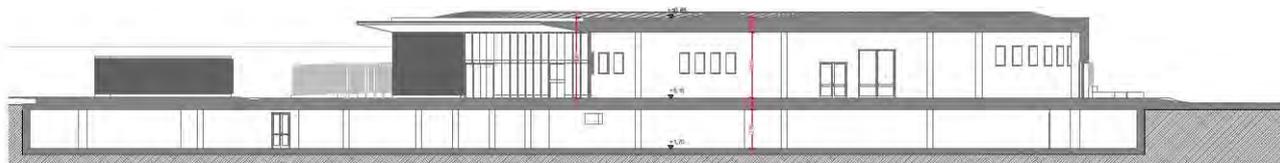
Prospetti e Sezione (Area commerciale e parcheggi)
